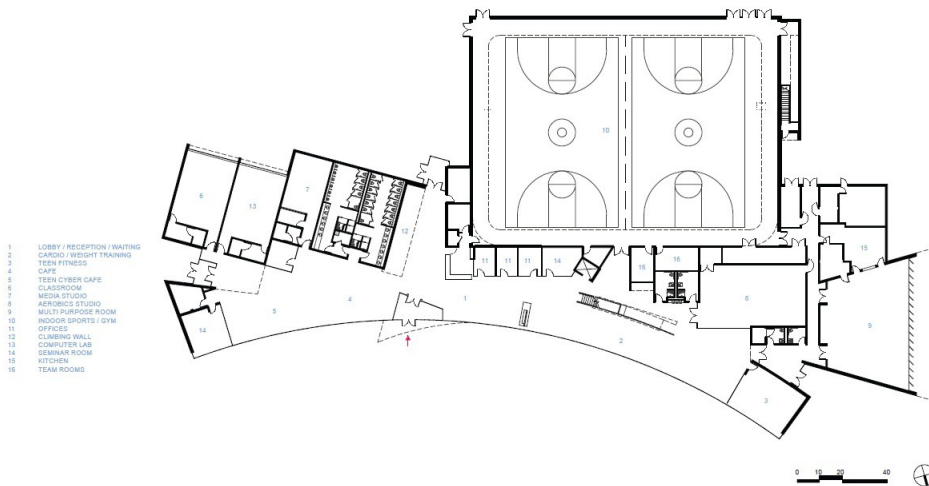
B Planta programa South Tec. Fuente: Arch Daily
